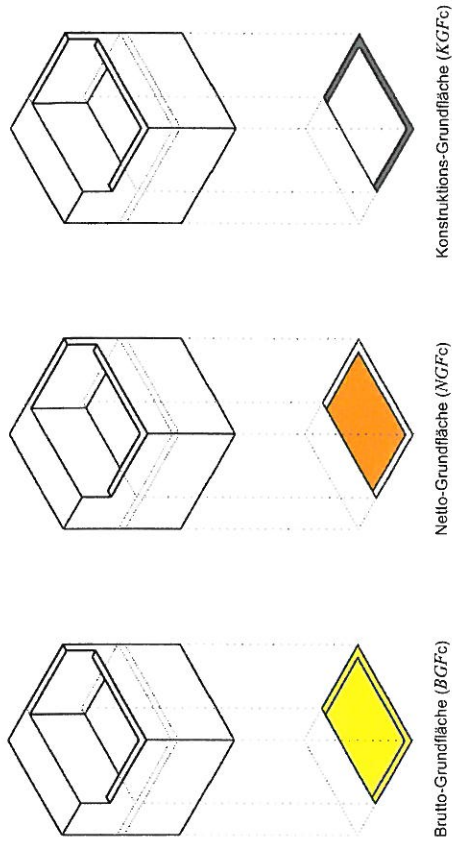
Geschossbezogene Grundflächen im Bereich c
